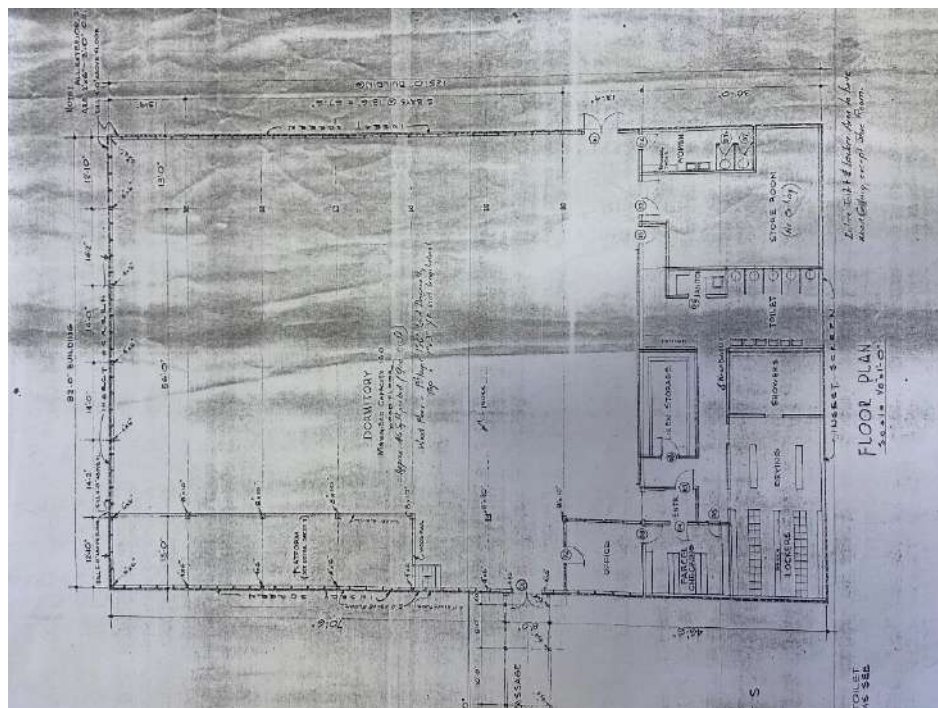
Planos Originales del Edificio Y.M.C.A., área del gimnasio (Dormitorio).
